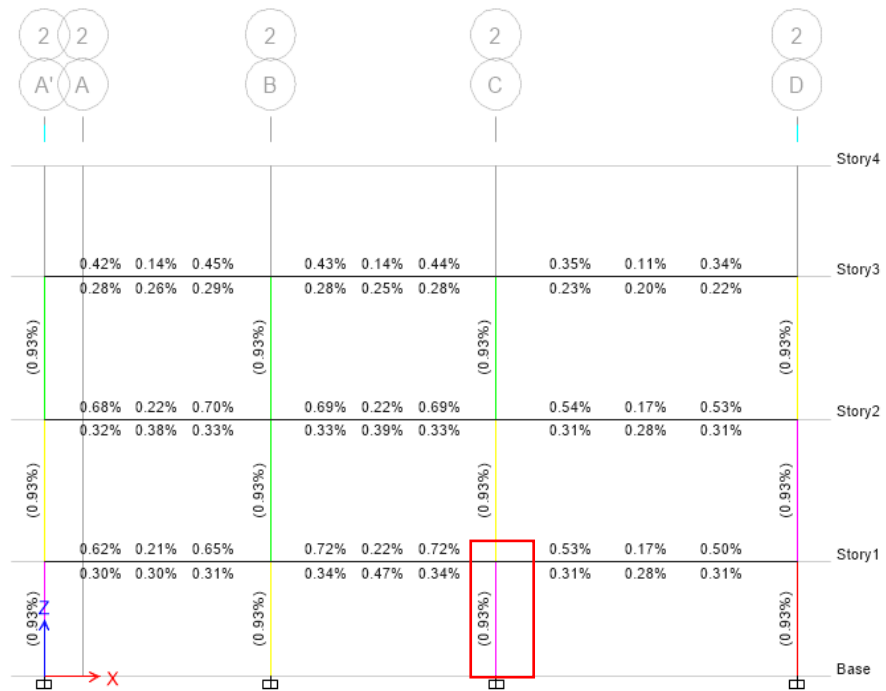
Acero de Refuerzo longitudinal en columnas
